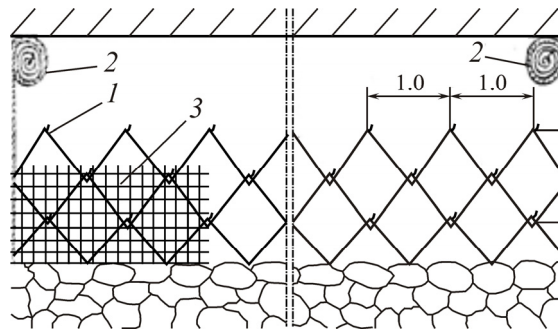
Монтаж перекрытия в наклонной части монтажного слоя: 1 — крюк; 2 — фланговый канат; 3 — металлическая лента
